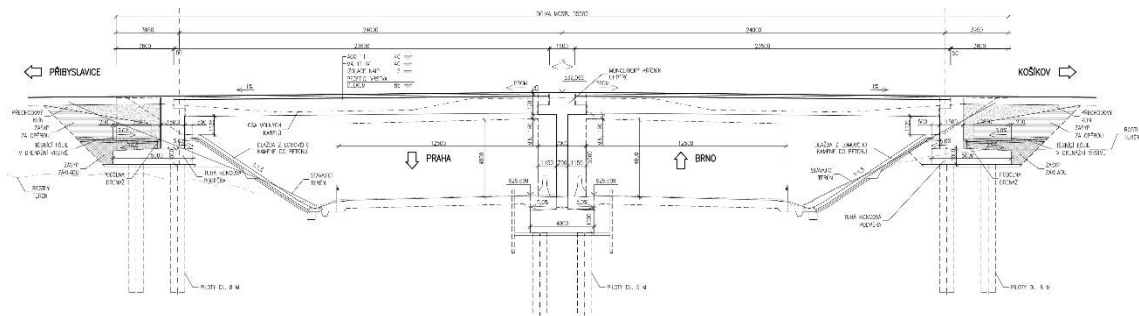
Varianta 1 - příčné řezy s pohledem na pilíř a opěru
